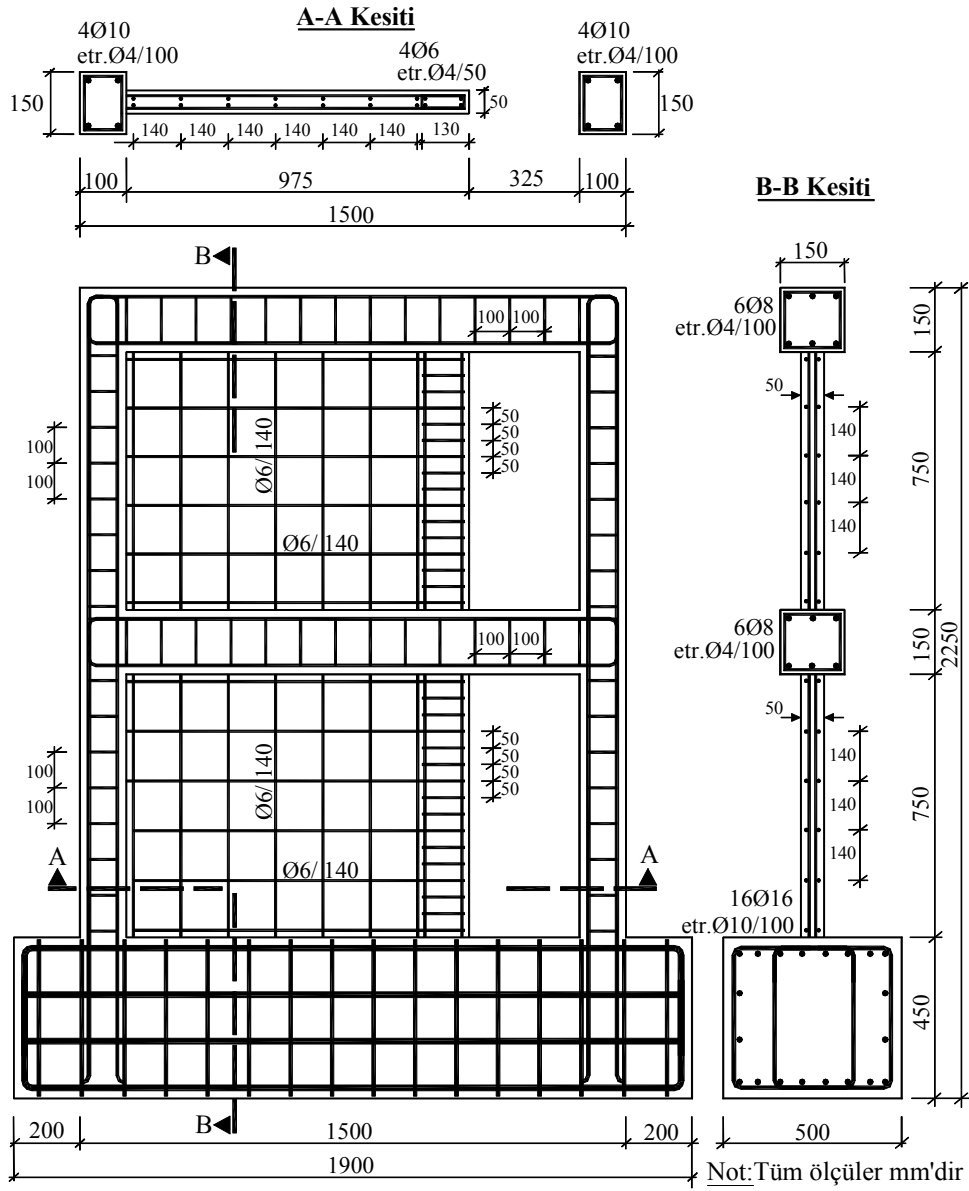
Deney Elemanı-4'ün filiz donatısı detayı
